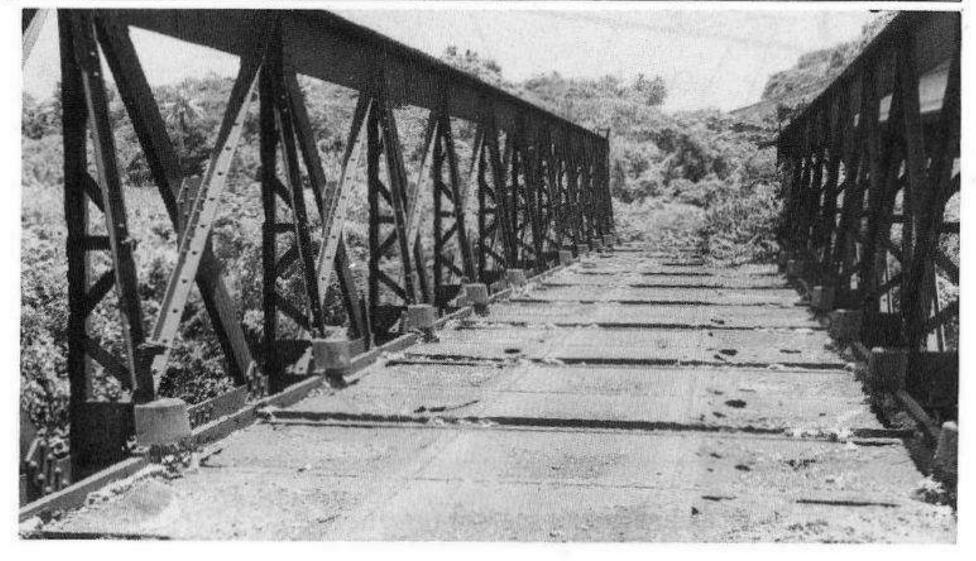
Elementos de un puente de armadura de tablero inferior.
